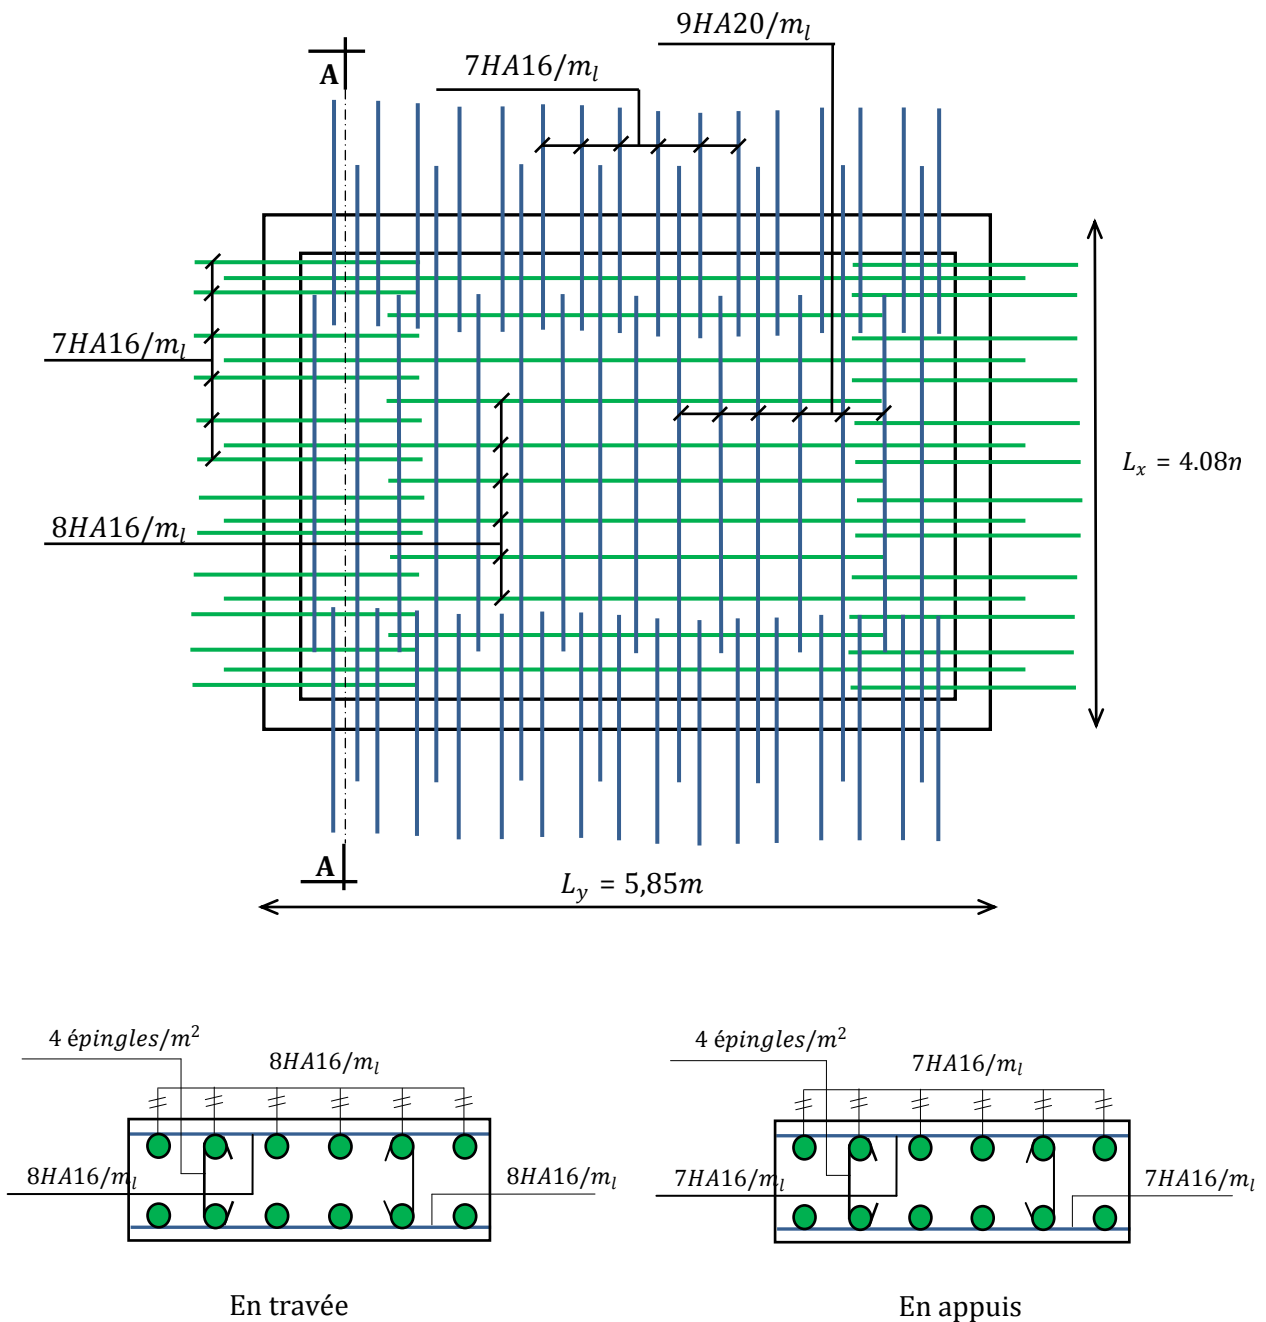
Schéma du ferrailage du mur adossé de 12.72m de hauteur.
